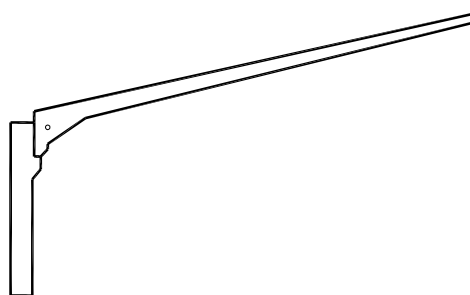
Конструкция узла соединения ригеля со стойкой [148]
